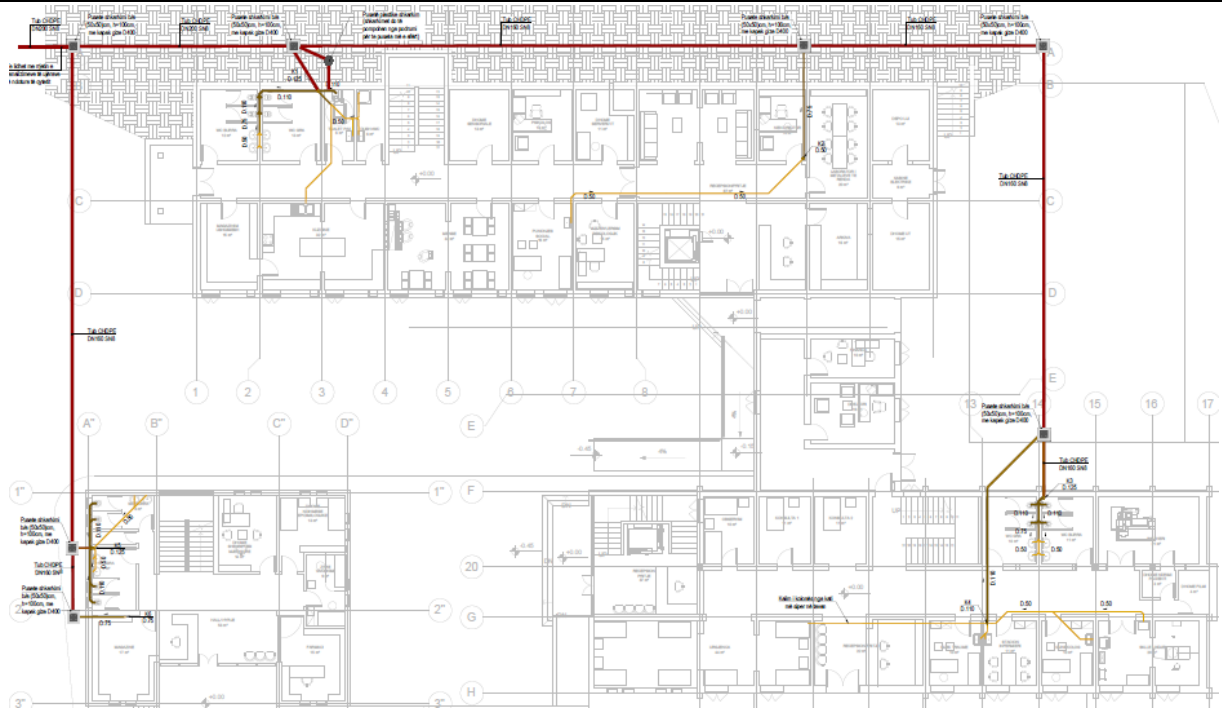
Planimetri e Shkarkimit të ujërave të Ndotura
